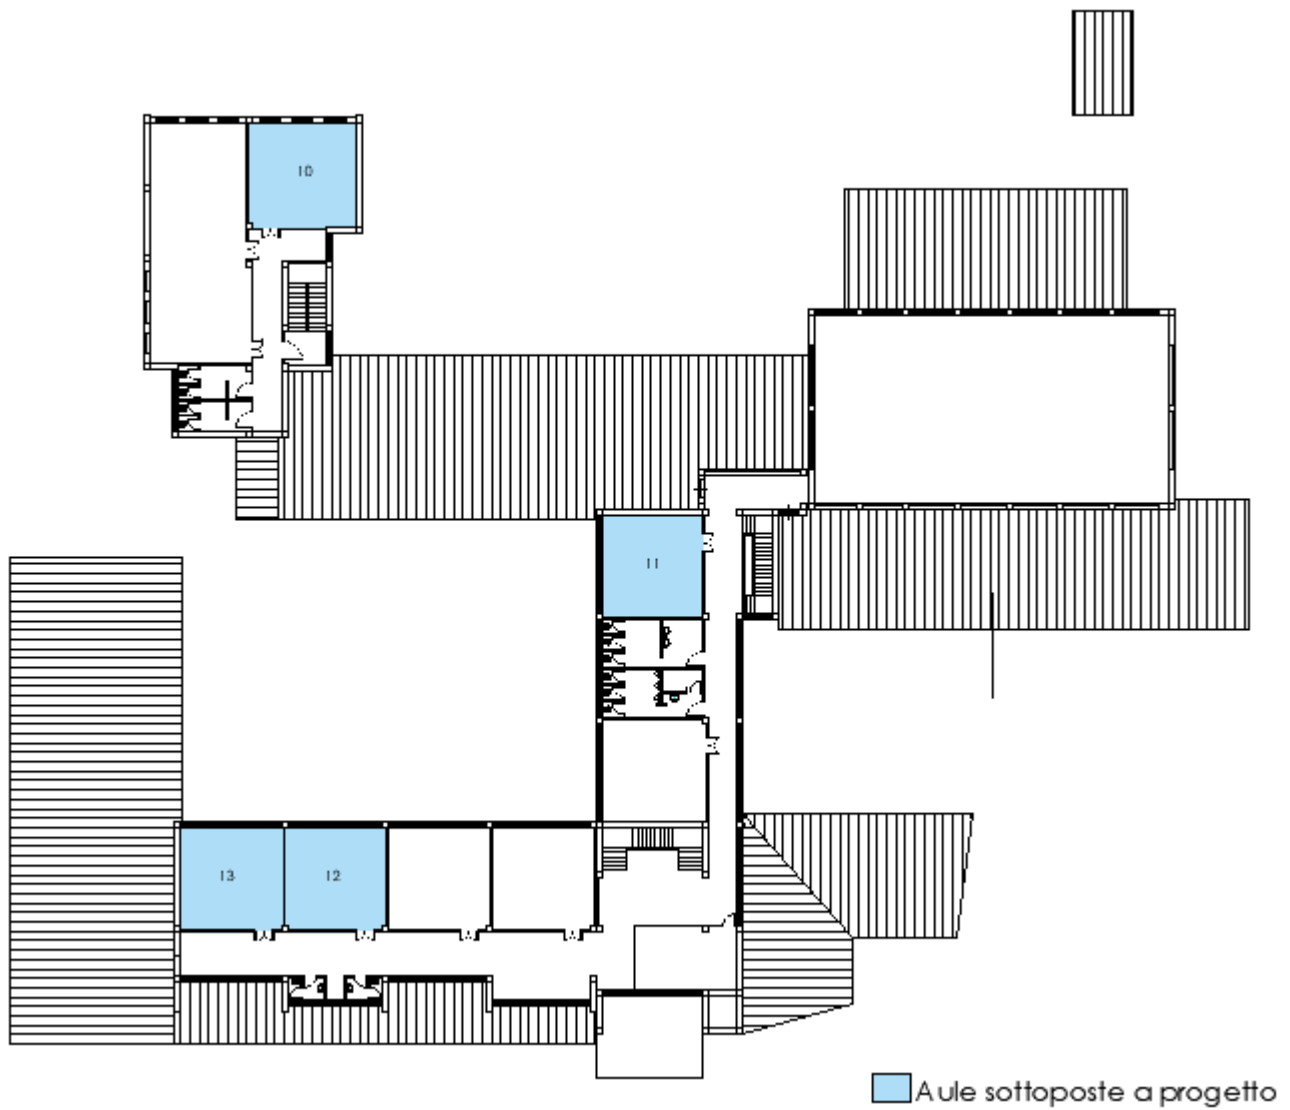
Planimetria generale piano primo_plesso di via Ferrentino, scuola primaria
